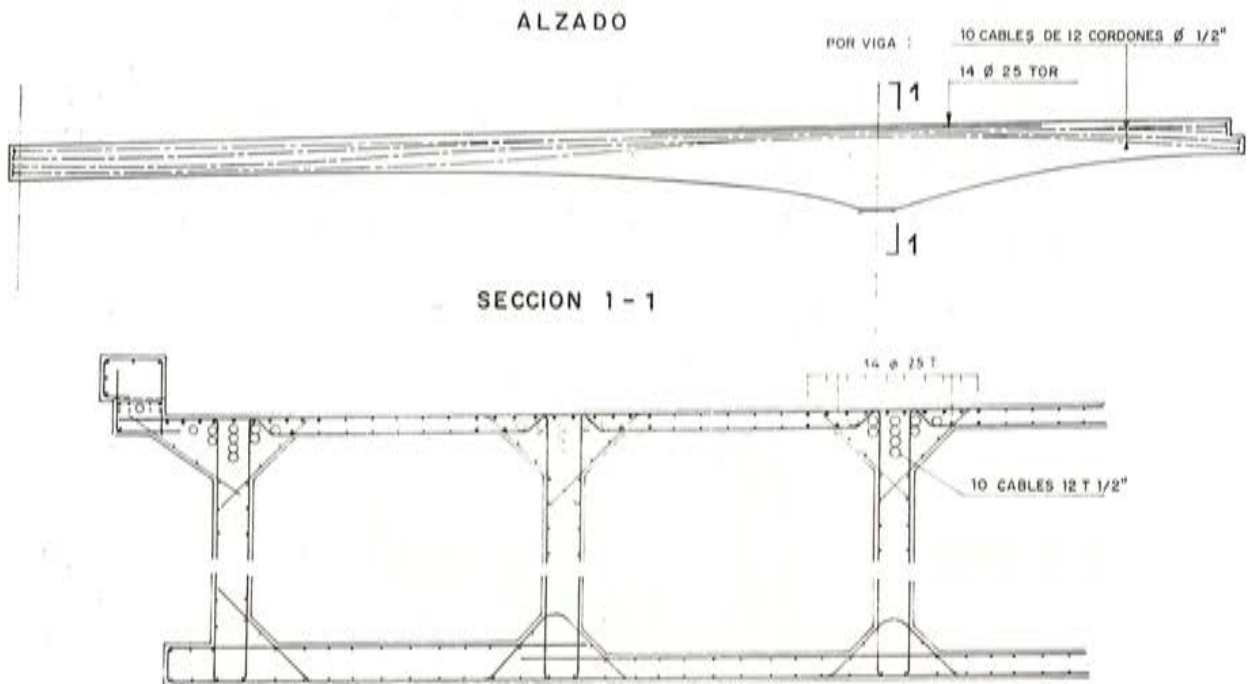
Viaducto de Alost. Tramo en voladizo. Trazado de cables y distribución de armaduras.
